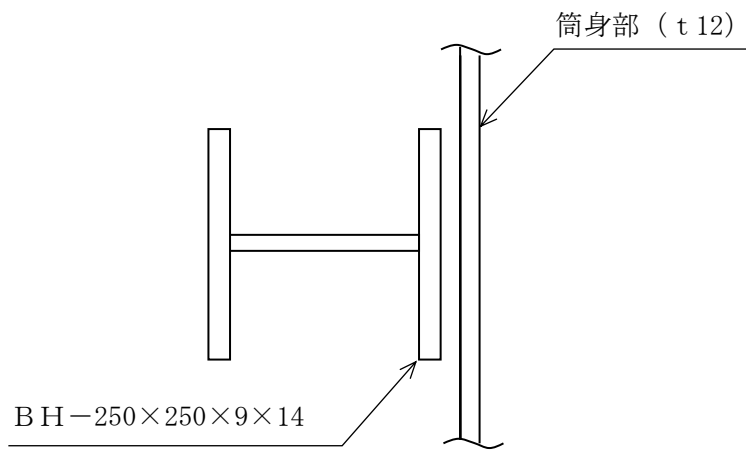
(4) 補強リングの構成断面 (単位 : mm)
